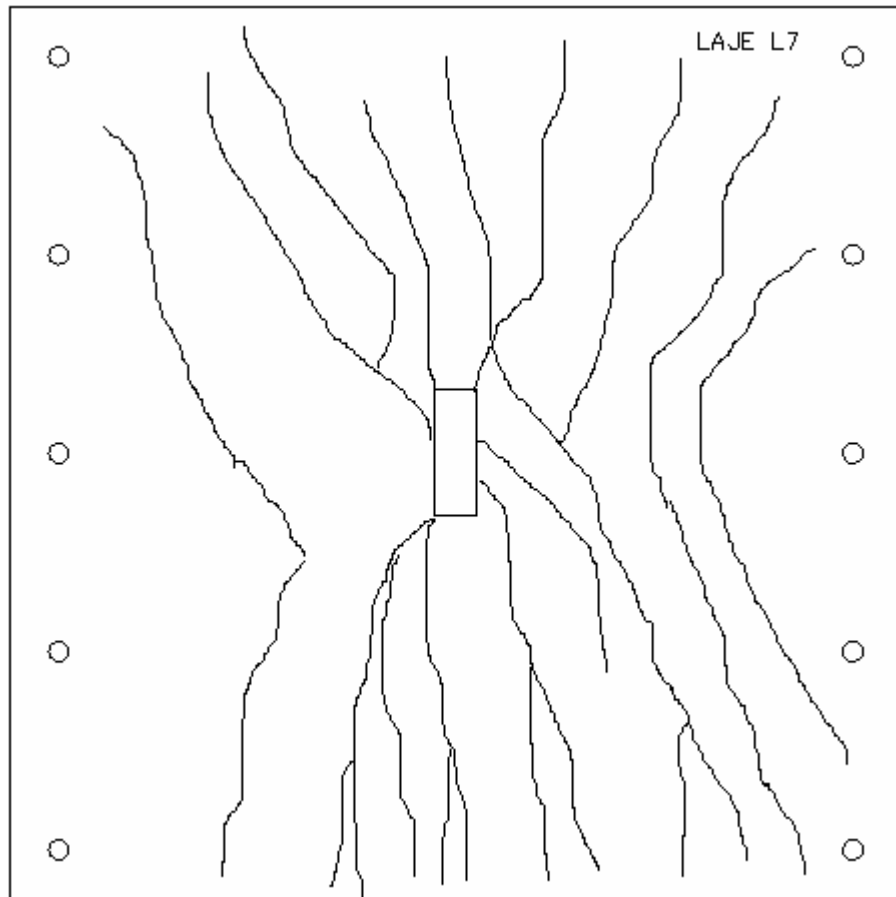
Mapa de fissuração da laje L7
